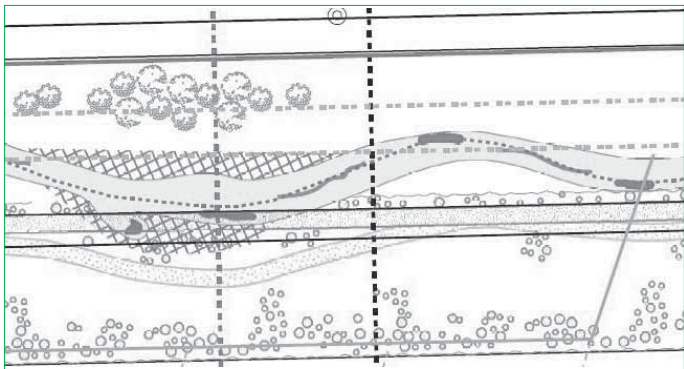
Ausschnitt aus dem Projekt-Situationsplan.
